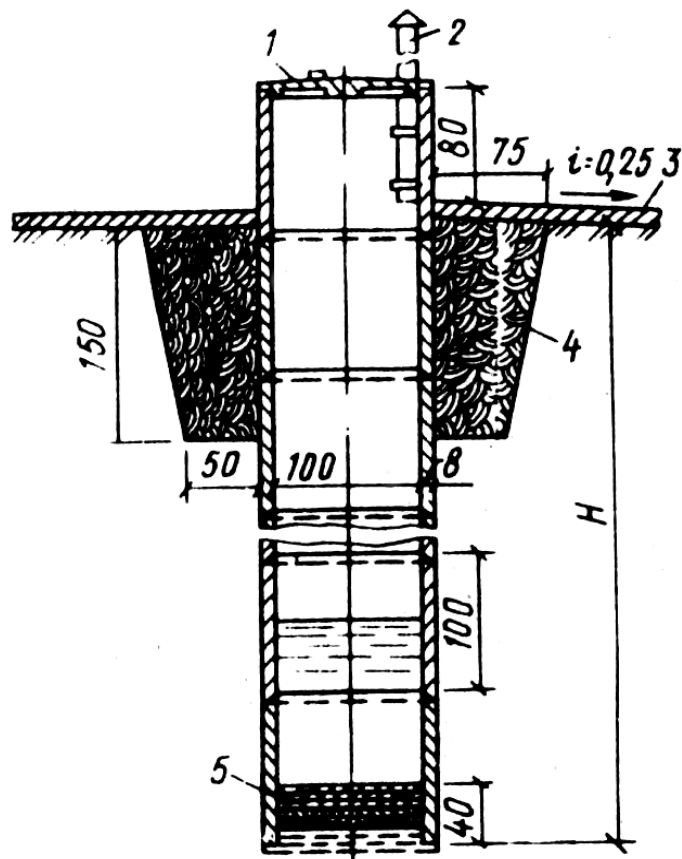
Шахтный колодец из железобетонных колец: 1 – железобетонная крышка, 2 – вентиляционная асбестовая труба диаметром 150 мм; 3 – отмостка щебнем (слоем 10 см), втрамбованным в грунт; 4 – глиняный замок; 5 – обратный фильтр
